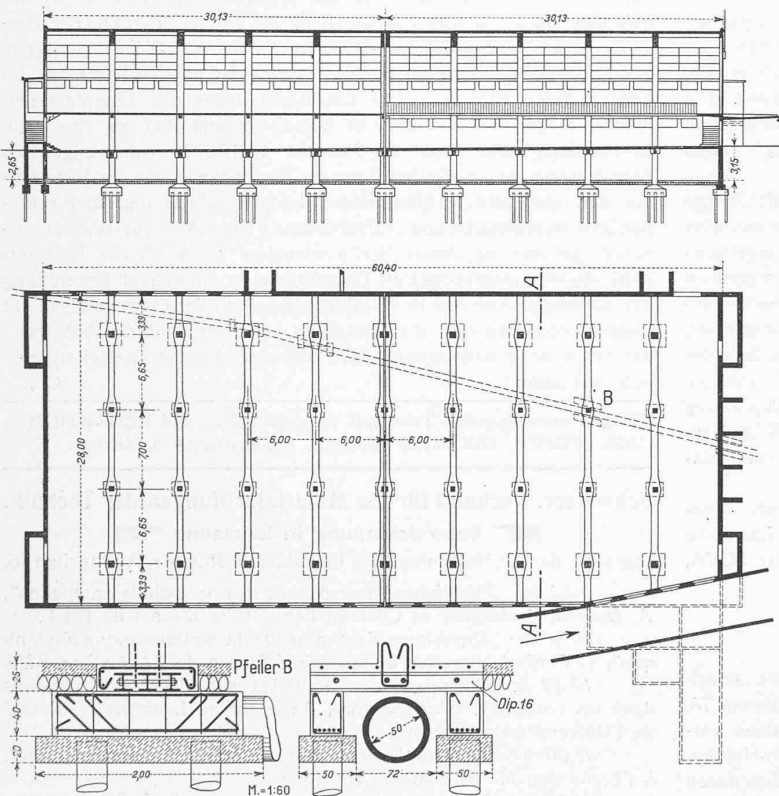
bis 9. Längsschnitt und Grundriss der Markthalle 1 : 600; Detail von Pfeiler B.
